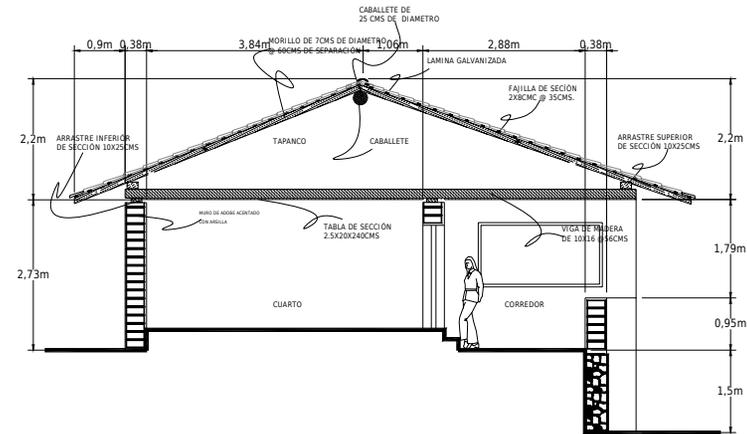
CORTE CONSTRUCTIVO DE LA FICHA No. 2
